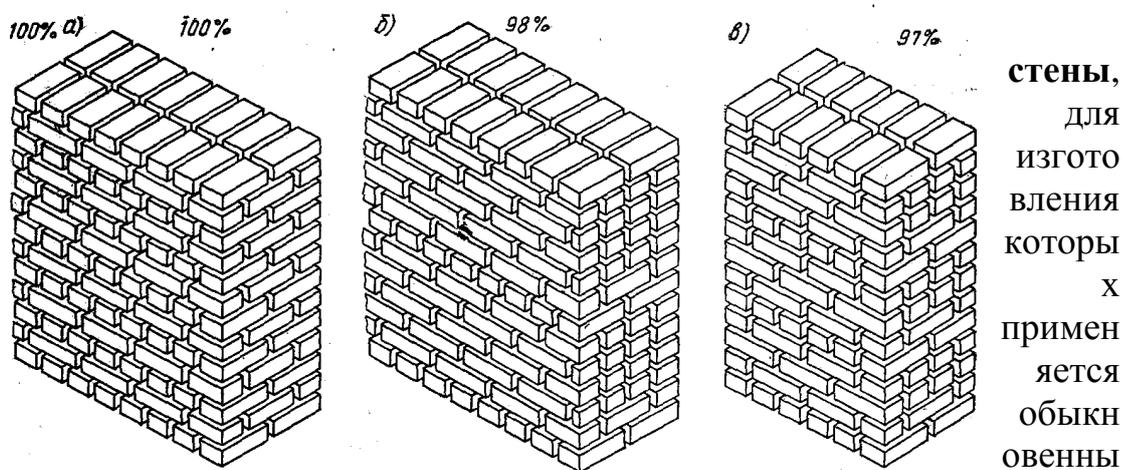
а – цепная кладка стены; б – шестирядная (ложковая перевязка) кладка; г – трехрядная кладка
